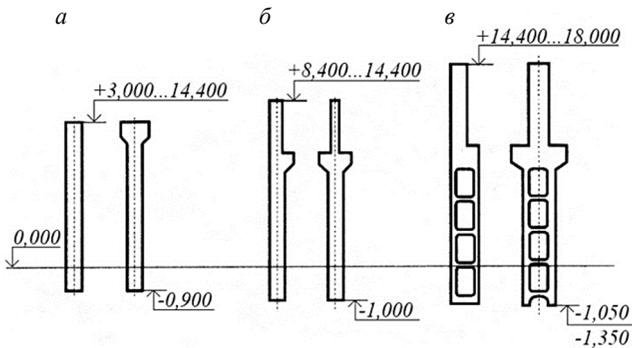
Типы железобетонных колонн крайних и средних:
